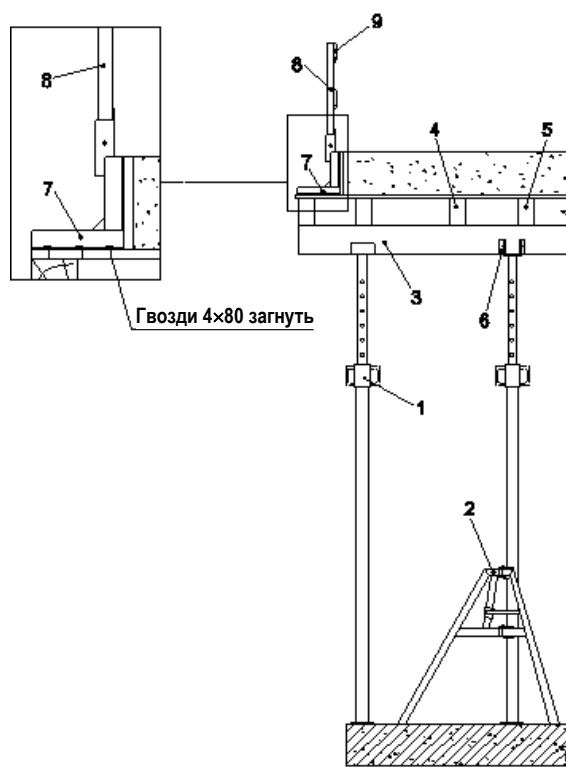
Схема устройства опалубки контура монолитного перекрытия:
